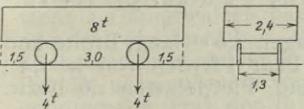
Für Brücken über 20 m Stützweite in Hauptstraßen.
